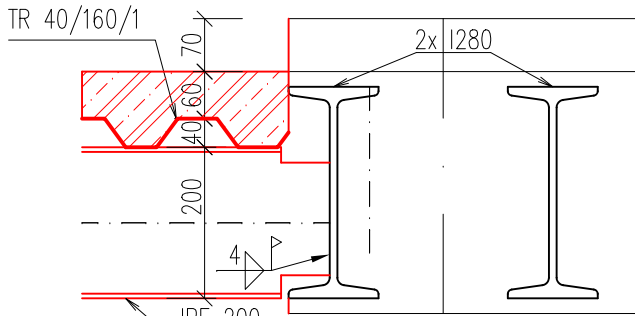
VYPLNĚNÍ PROSTORU MEZI STÁVAJÍCÍM
